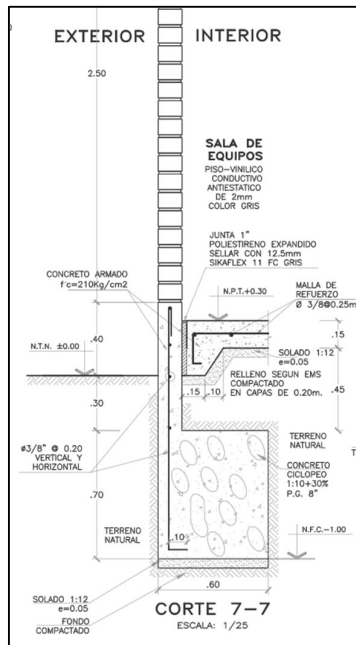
Extracto de Corte de cimentación y losa de sala de equipos
